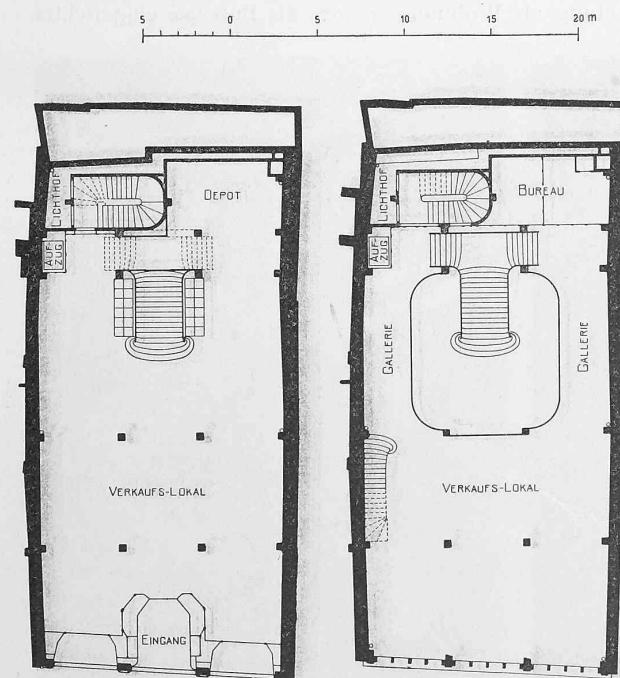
, 6, 7. Grundrisse vom Erdgeschoss, ersten und dritten Obergeschoss des Geschäftshauses G. Kiefer & Cie. — Masstab 1:400.
